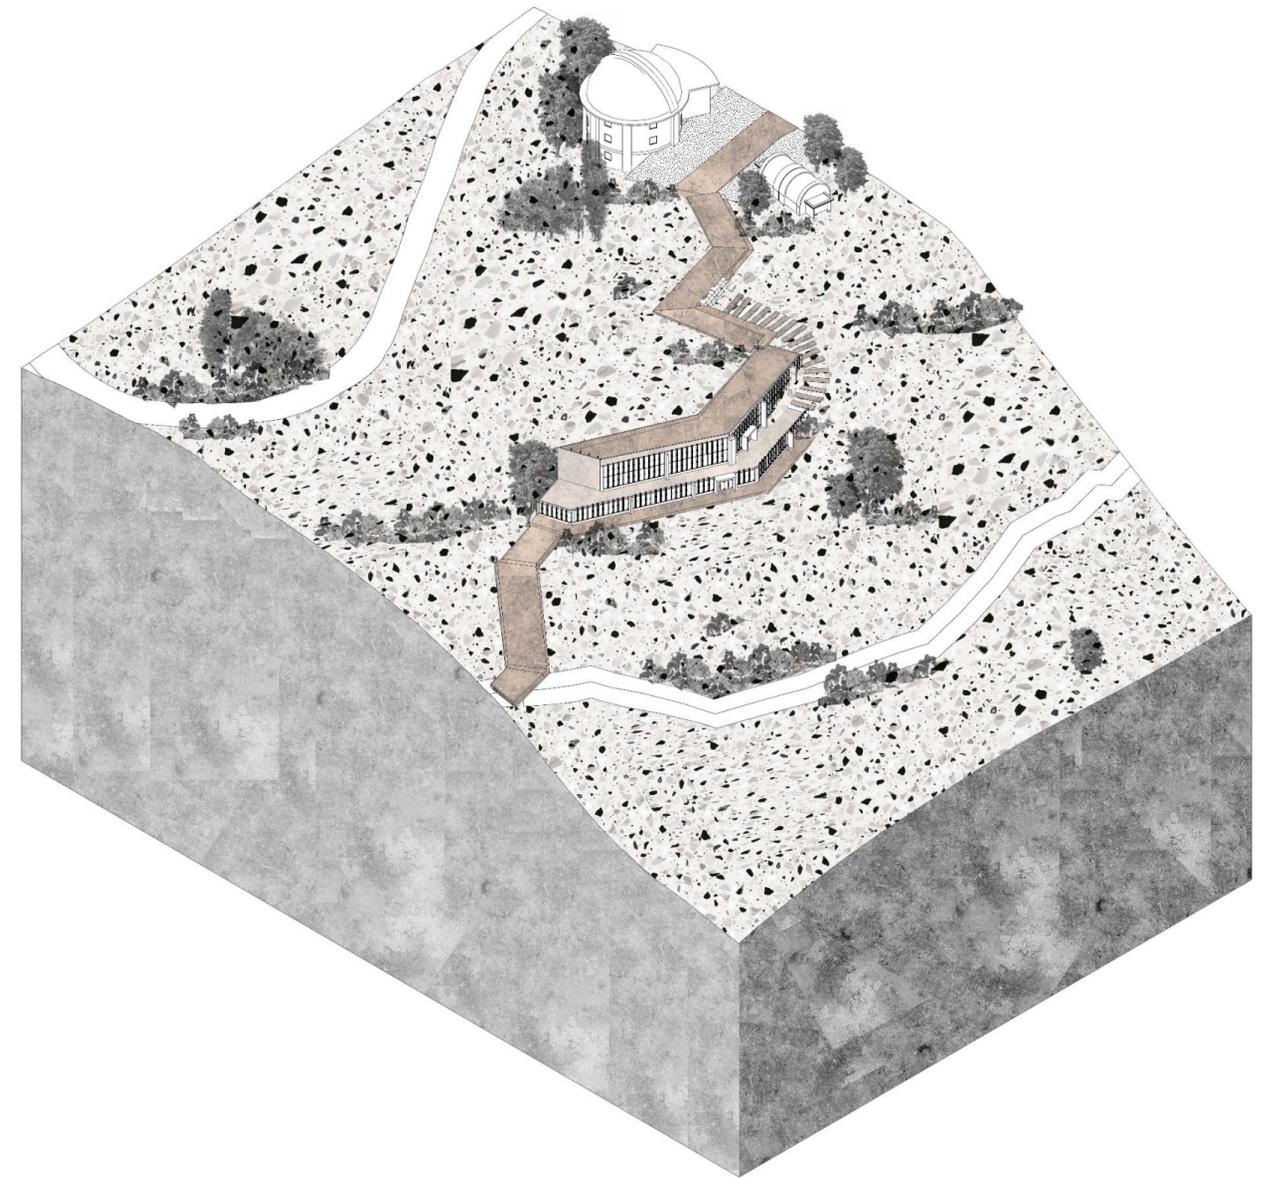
Planta. Detalle de los bordes entre la plataforma central con respecto a la infraestructura existente.
